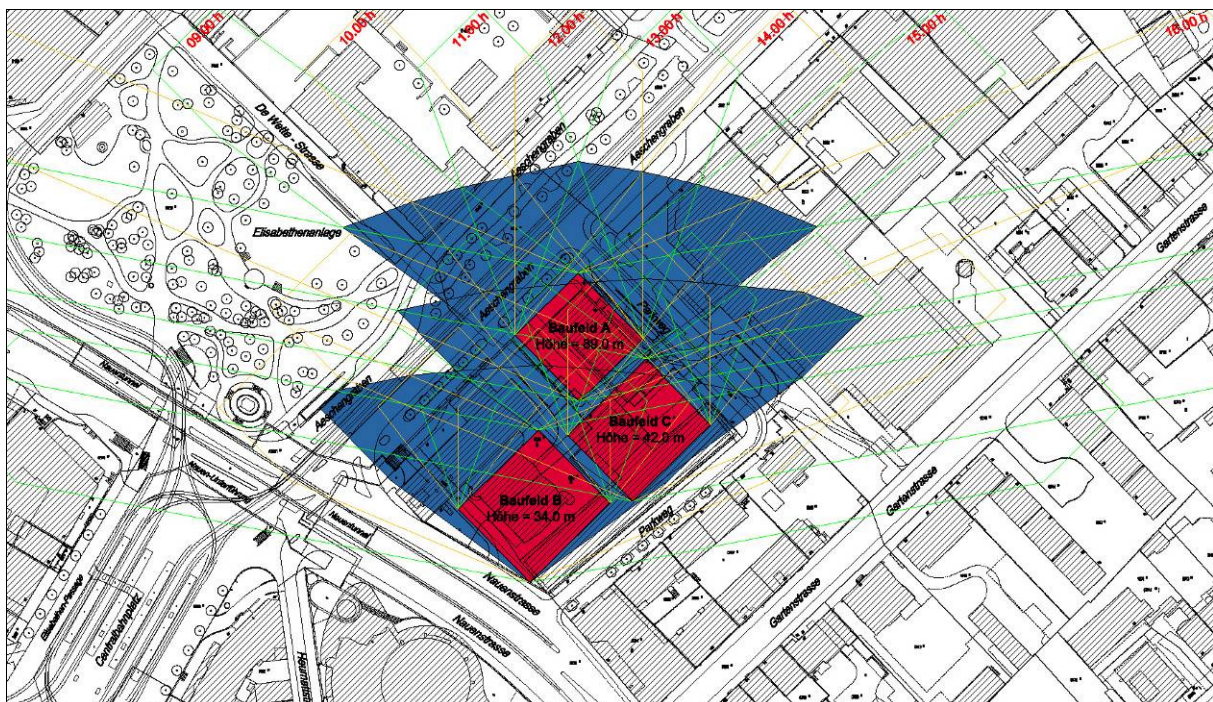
2-Stunden-Schatten (Plan genordet, ohne Massstab)
